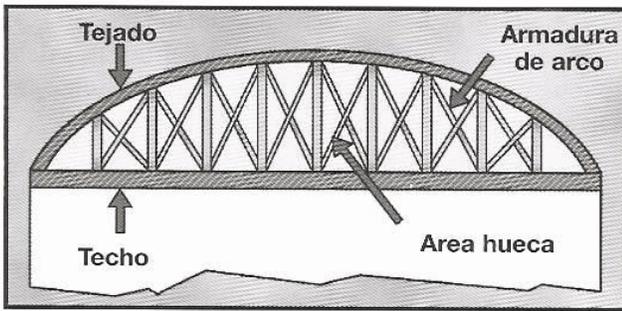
Observe las grandes áreas abiertas en la estructura armada del tejado.
